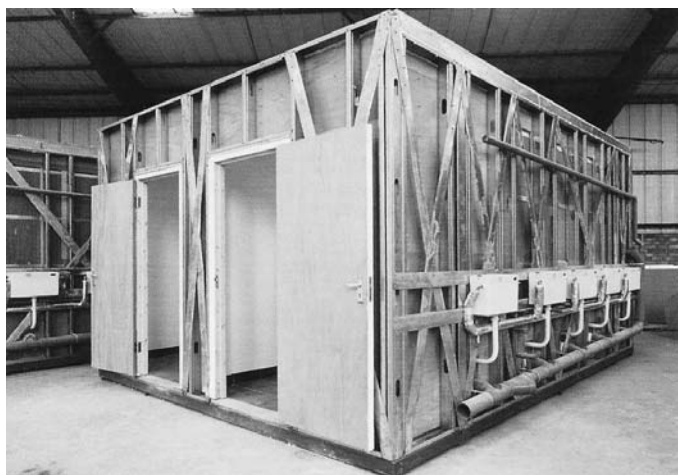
Módulo de baño. (Fuente: SCI)
